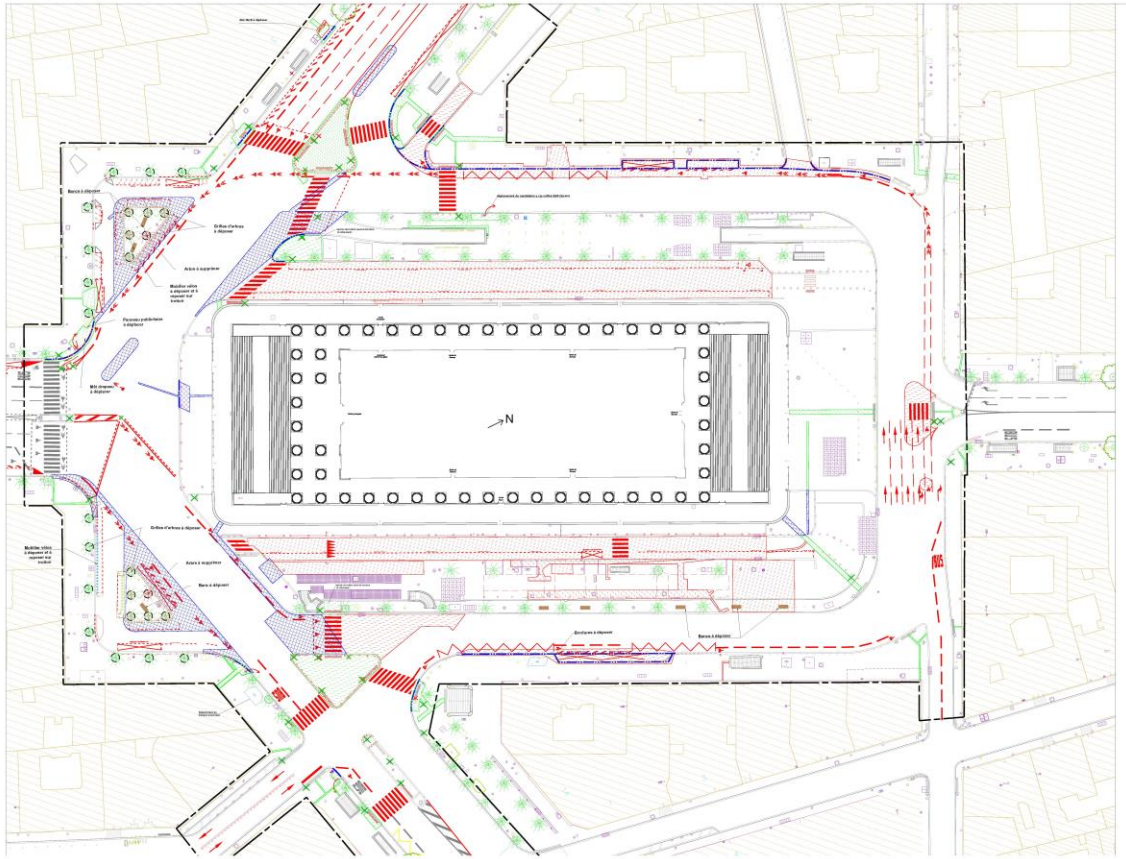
Plan de démolition (zones hachurées= zones d'intervention)- Place de la Madeleine (source: OGI)
